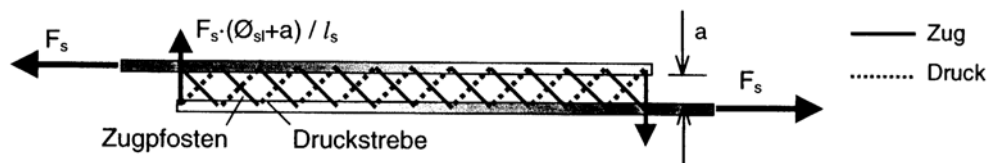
Lokales Fachwerk 1 von gestoßenen Bewehrungsstäben (*Schlaich/Schäfer (1998)*)
